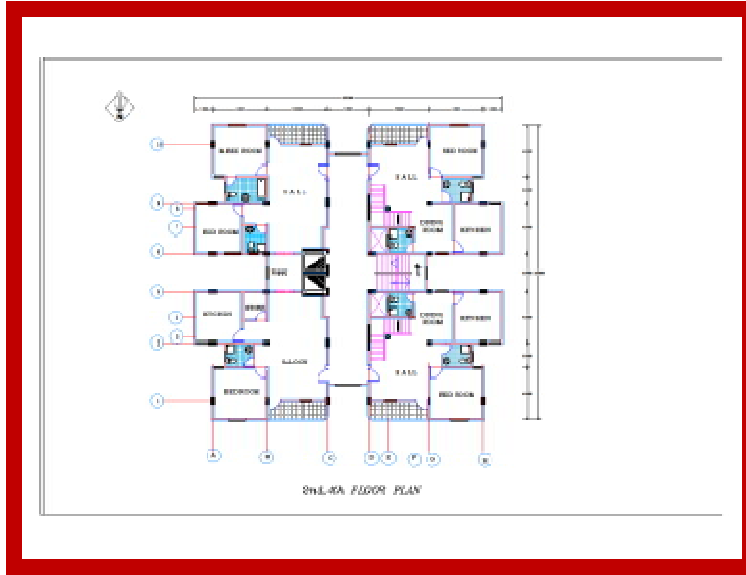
نموذج تصميم الطابق الارضي المساحات 144م² شكل (أ - 7) نموذج الطابق المتكرر 144م²
